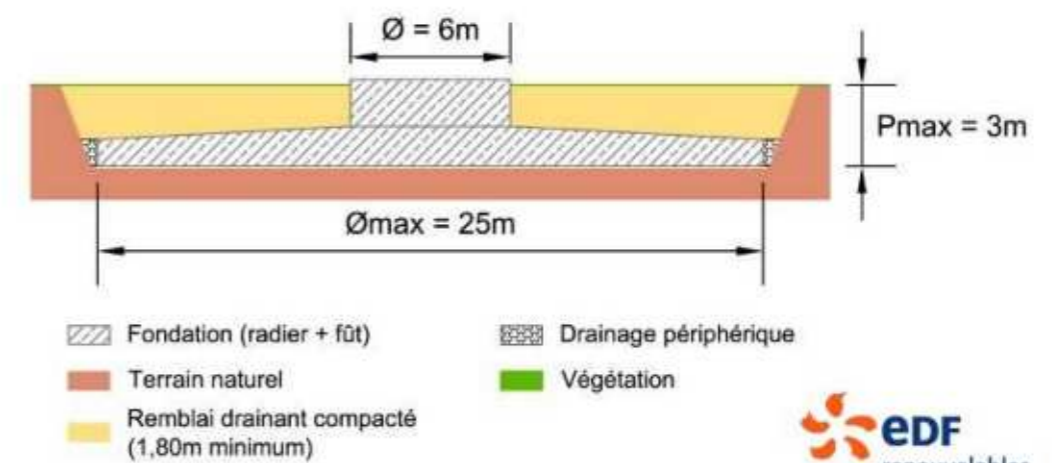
Principe de dimensionnement d'une fondation d'une éolienne
